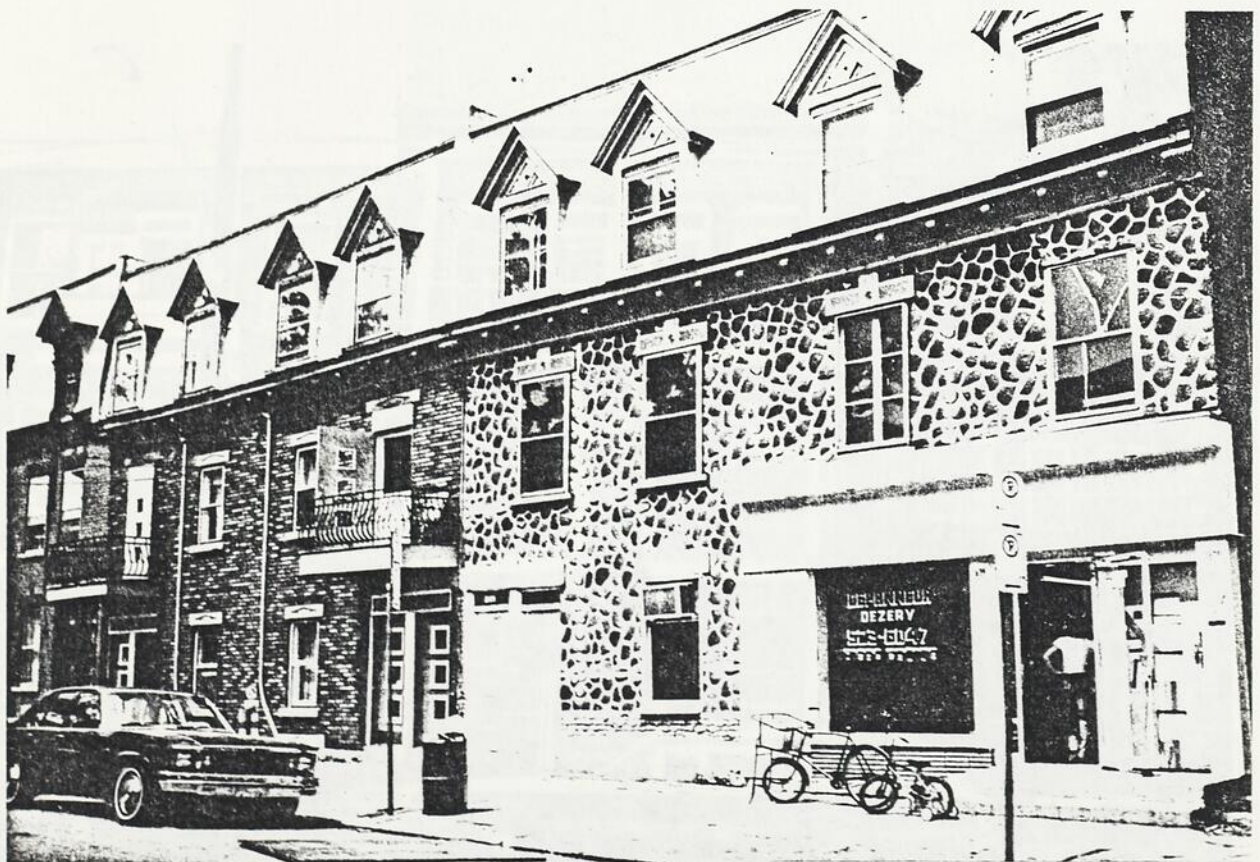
Modification au rez-de-chaussée et au revêtement, 1635-43 Dezery.
